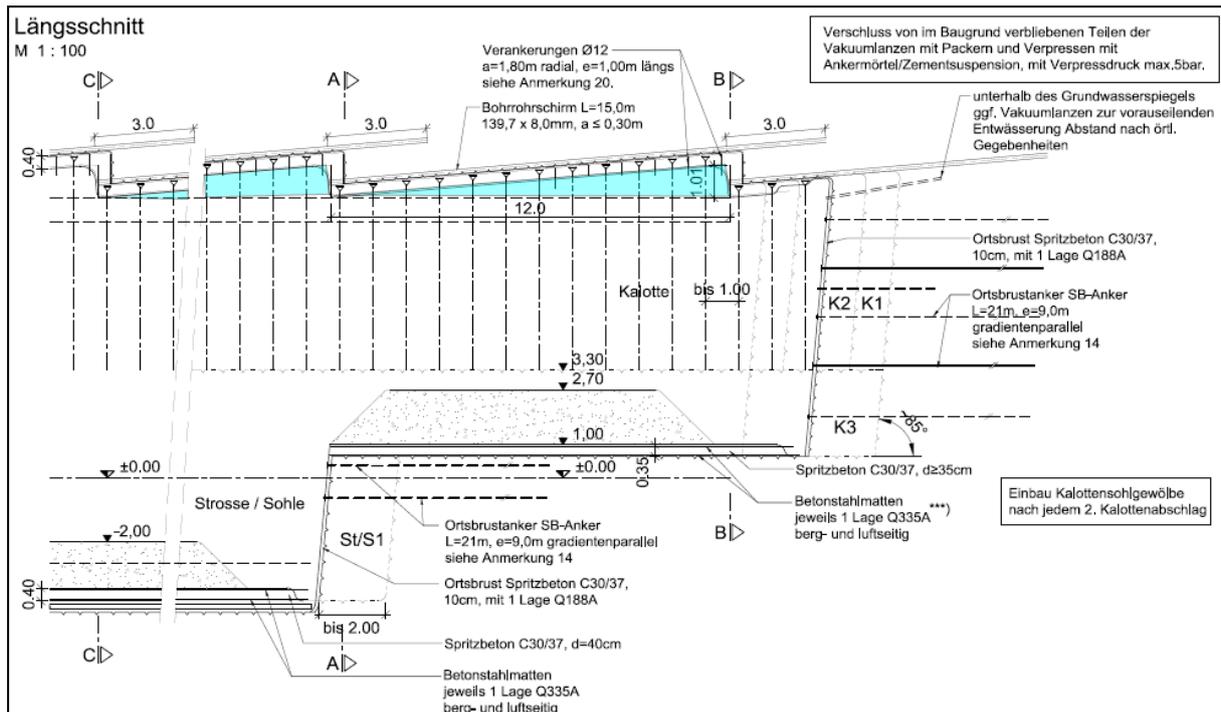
Längsschnitt der Rohrschirmkavernen, Stahlfaserspritzbeton farblich markiert (Bild: ILF Consulting Engineers)
